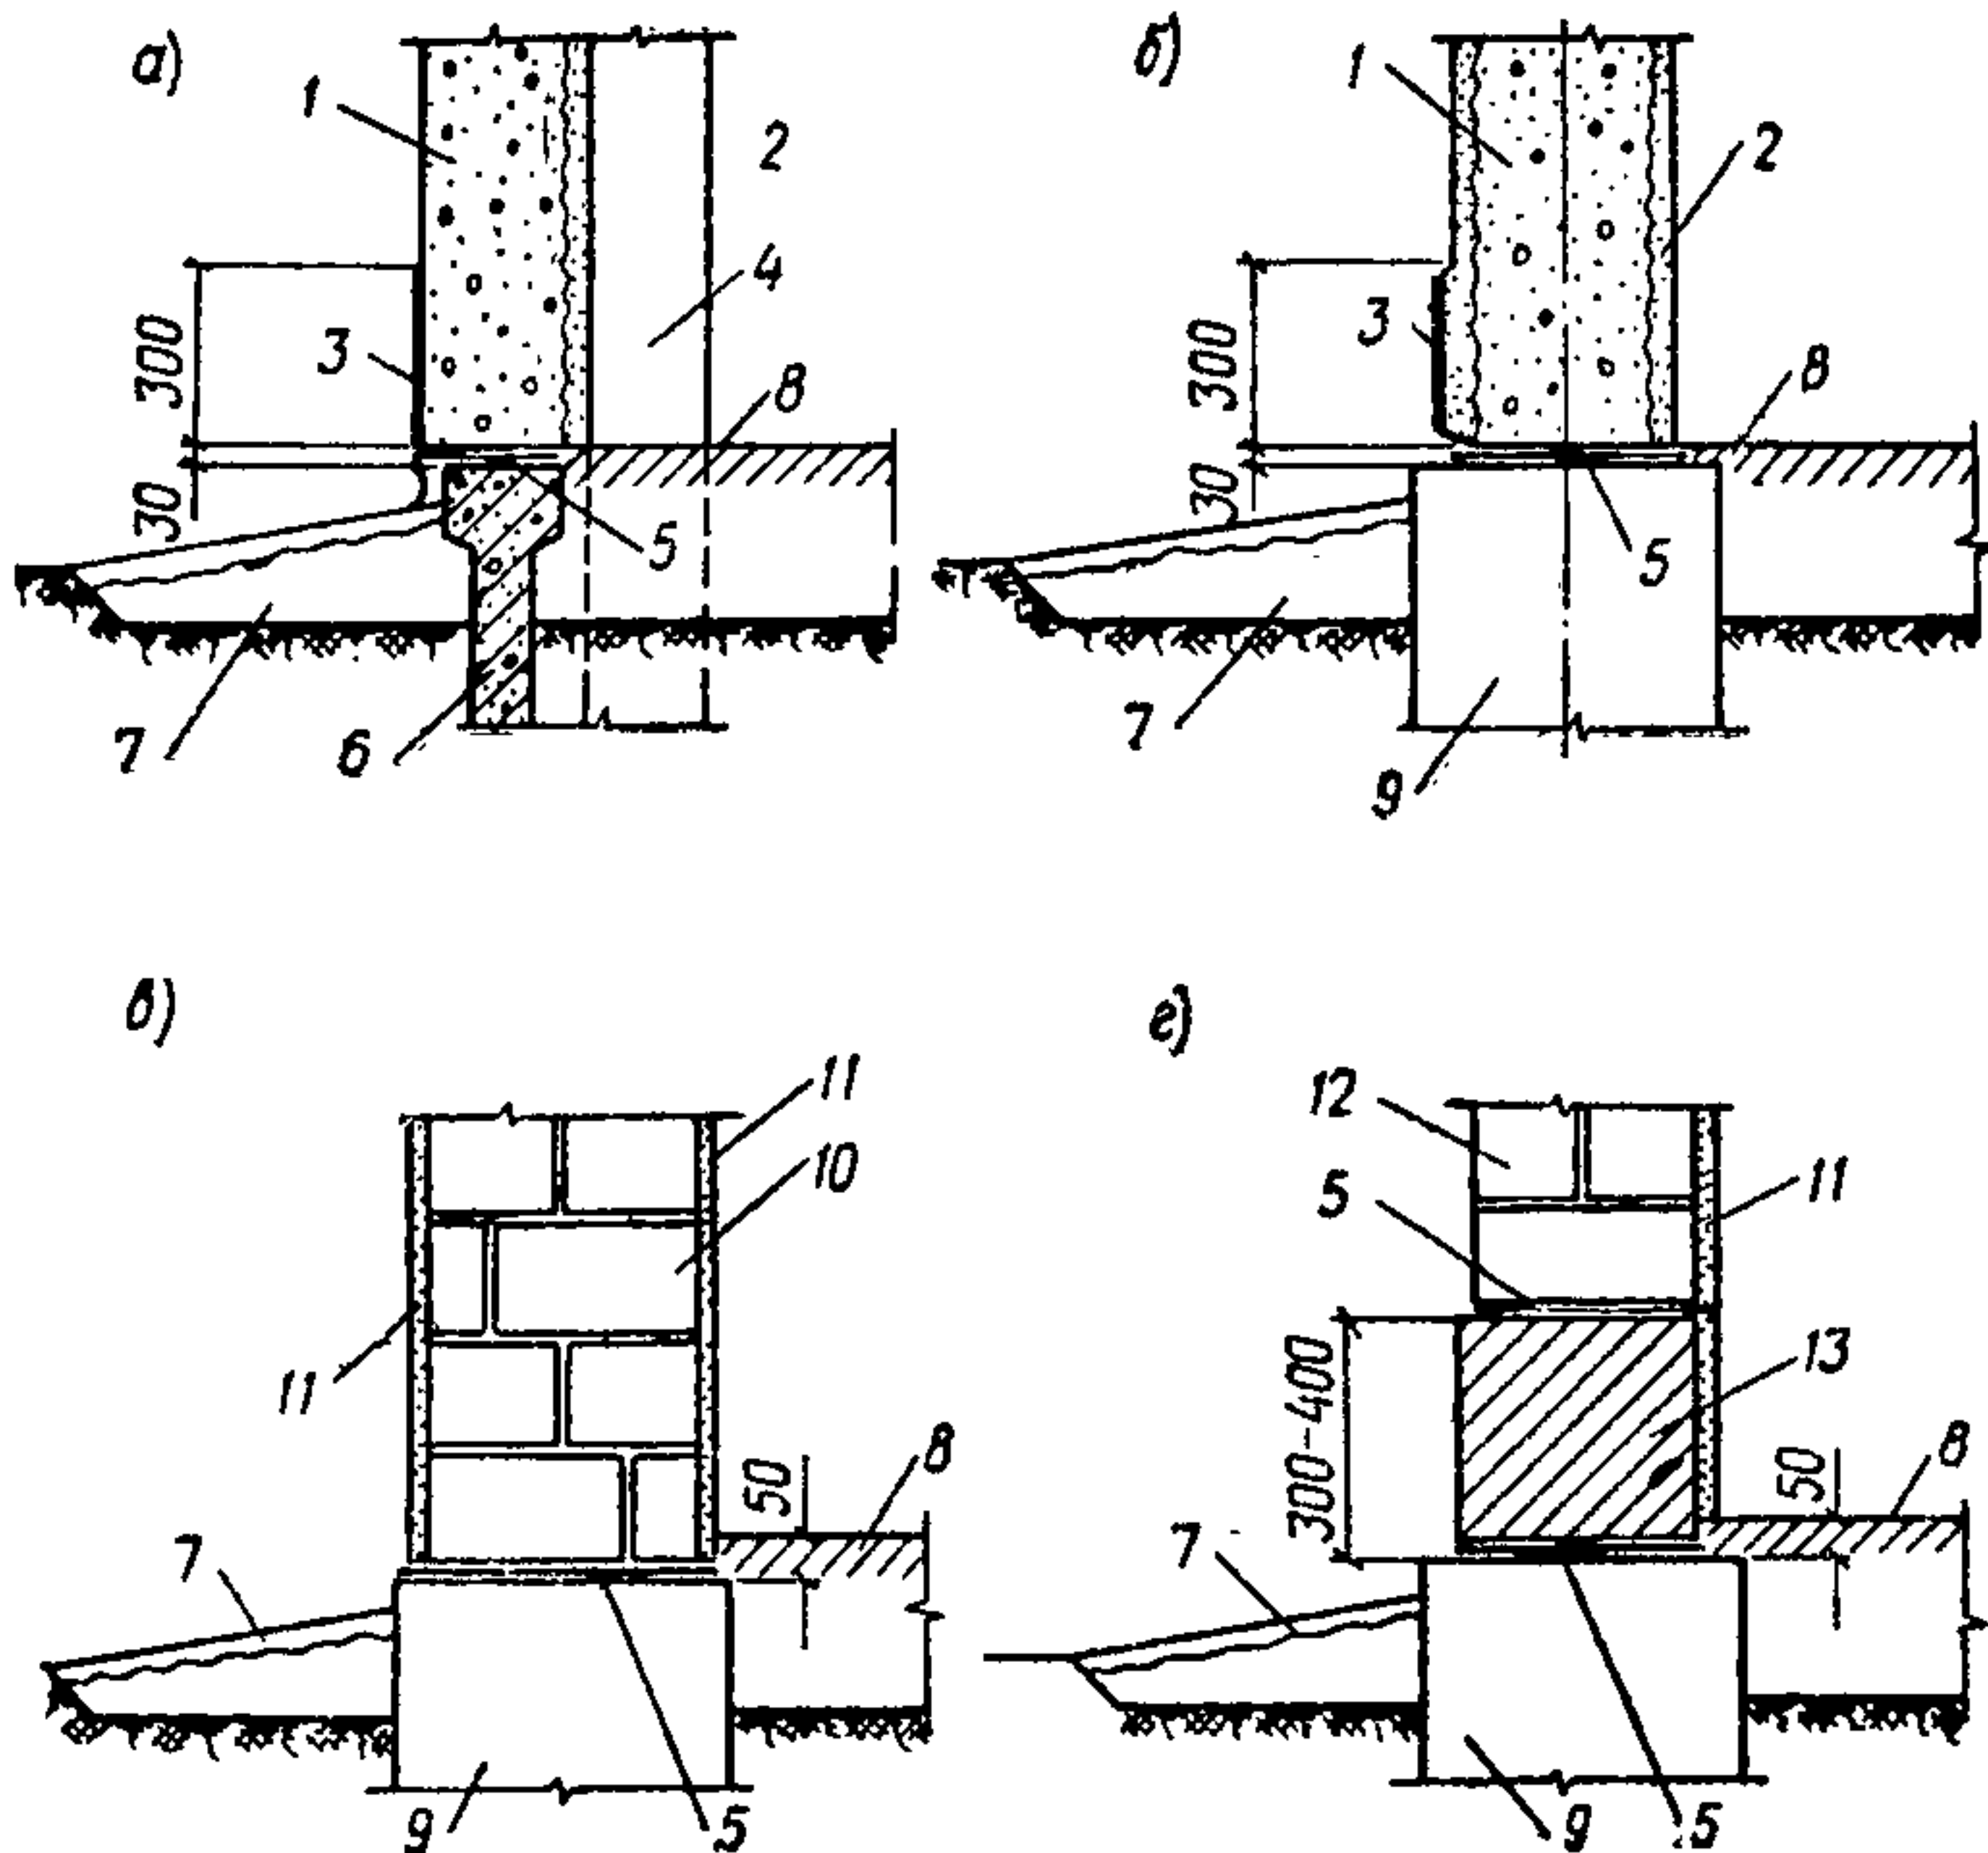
Примеры гидроизоляции наружных стен сельскохозяйственных производственных зданий
